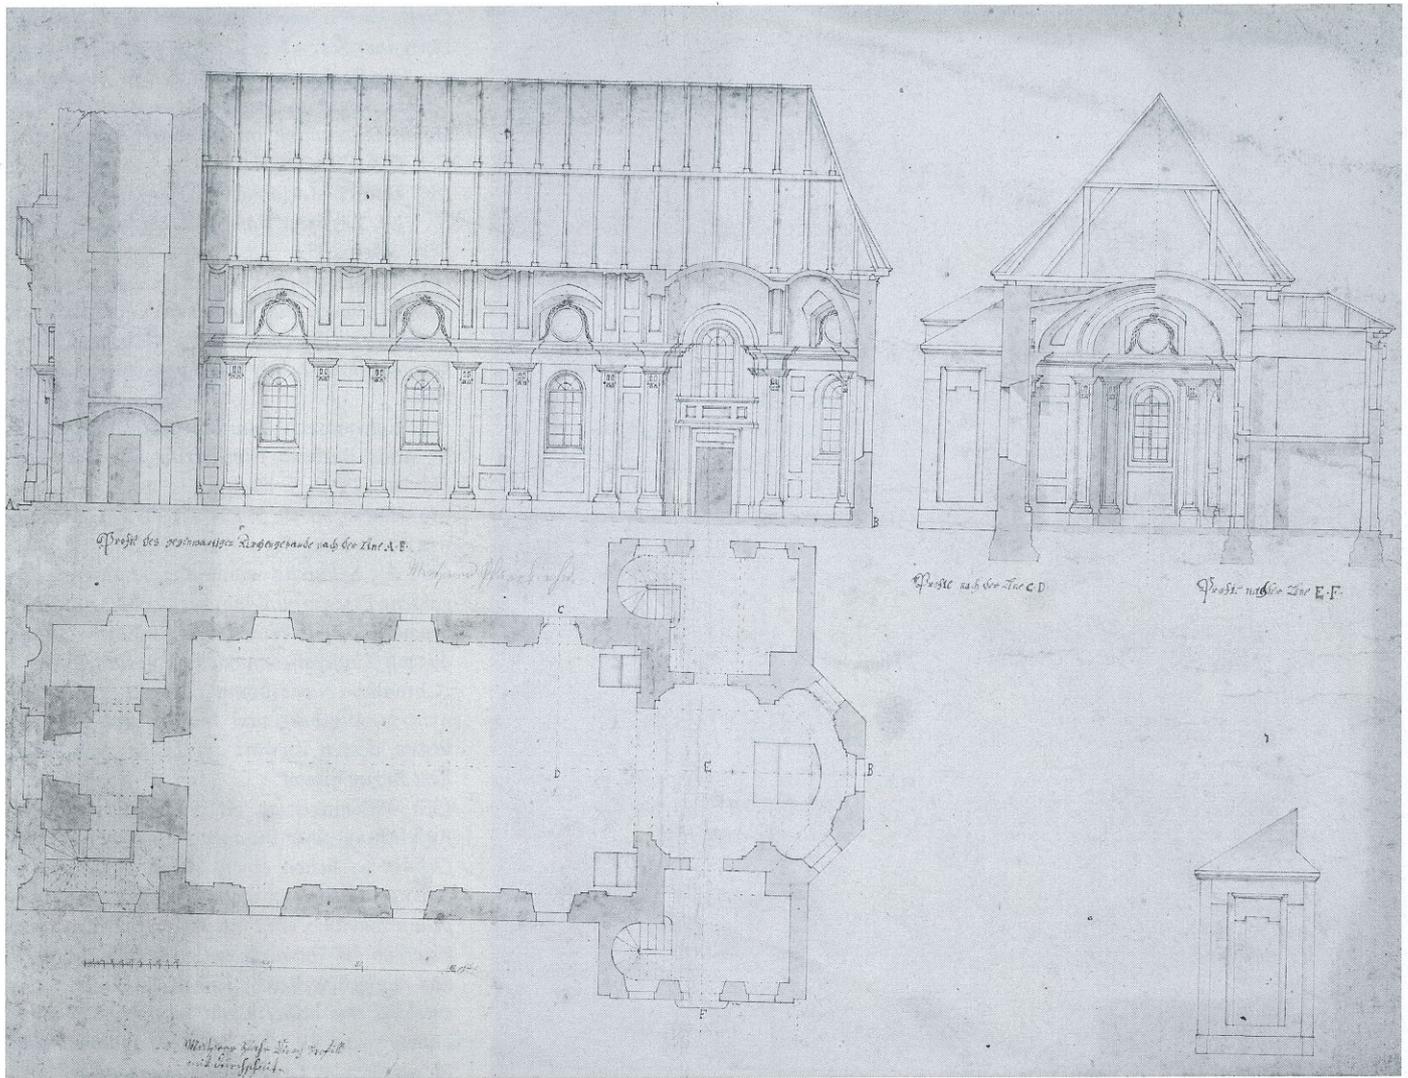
Wolfgang Hagenauer, Innenansichten und Grundrissplan der Pfarrkirche in Mattsee. Salzburger Museum C. A.
